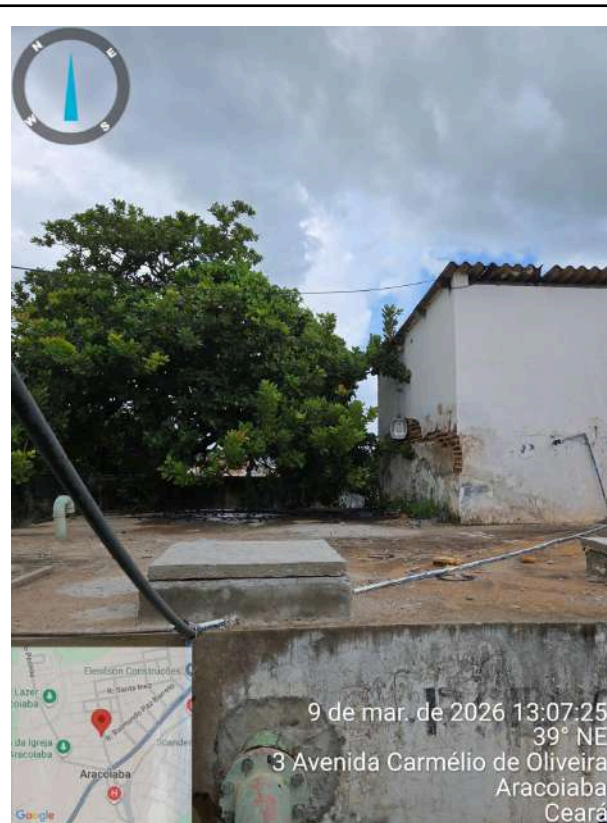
RSE-02: iluminação quebrada, tijolo aparente.
